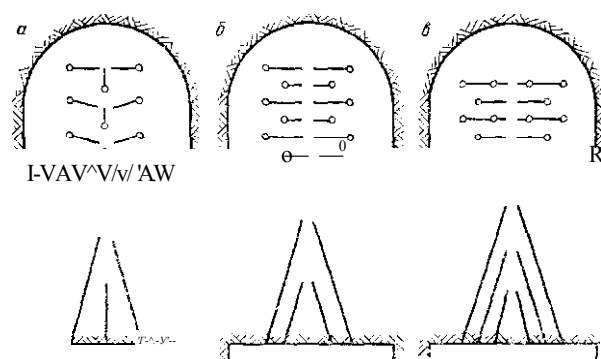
Примерные схемы расположения шпуров клиновых врубов: а - одноступенчатый с разрезными шпурами; б - двухступенчатый; в - трехступенчатый
